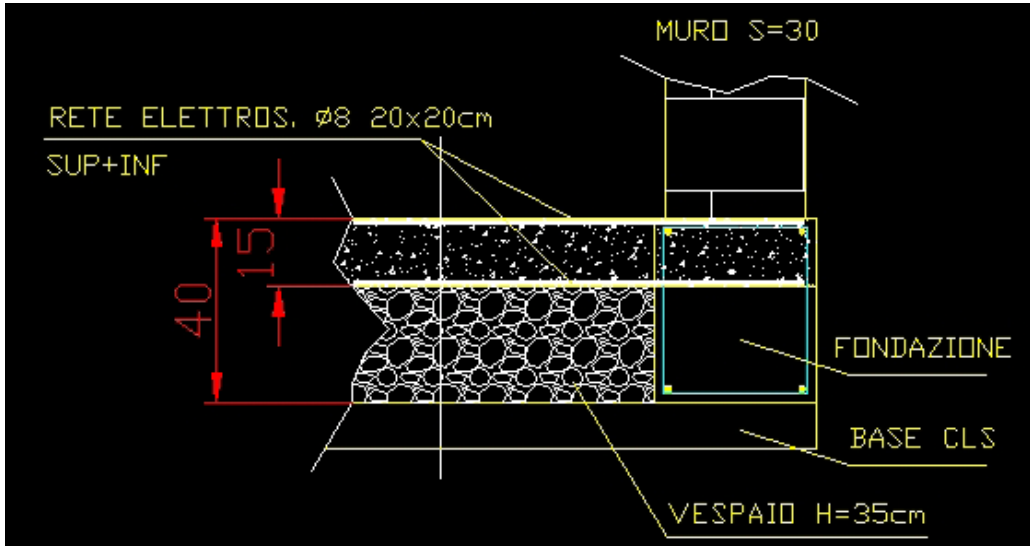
Dettaglio della fondazione per la soluzione con muratura portante.
